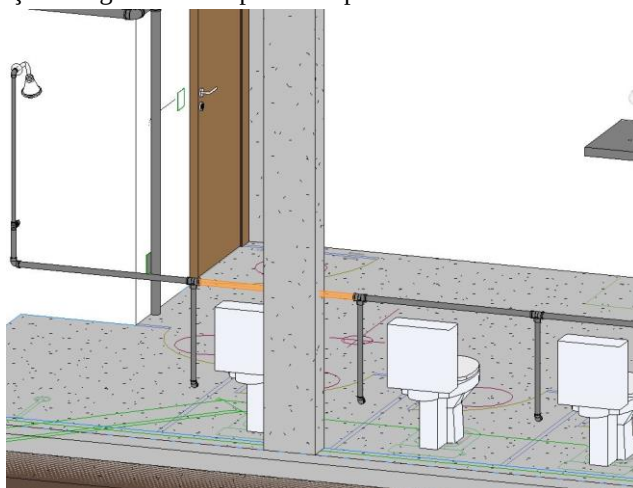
Demonstração de tubulação embutida após a execução da obra.
